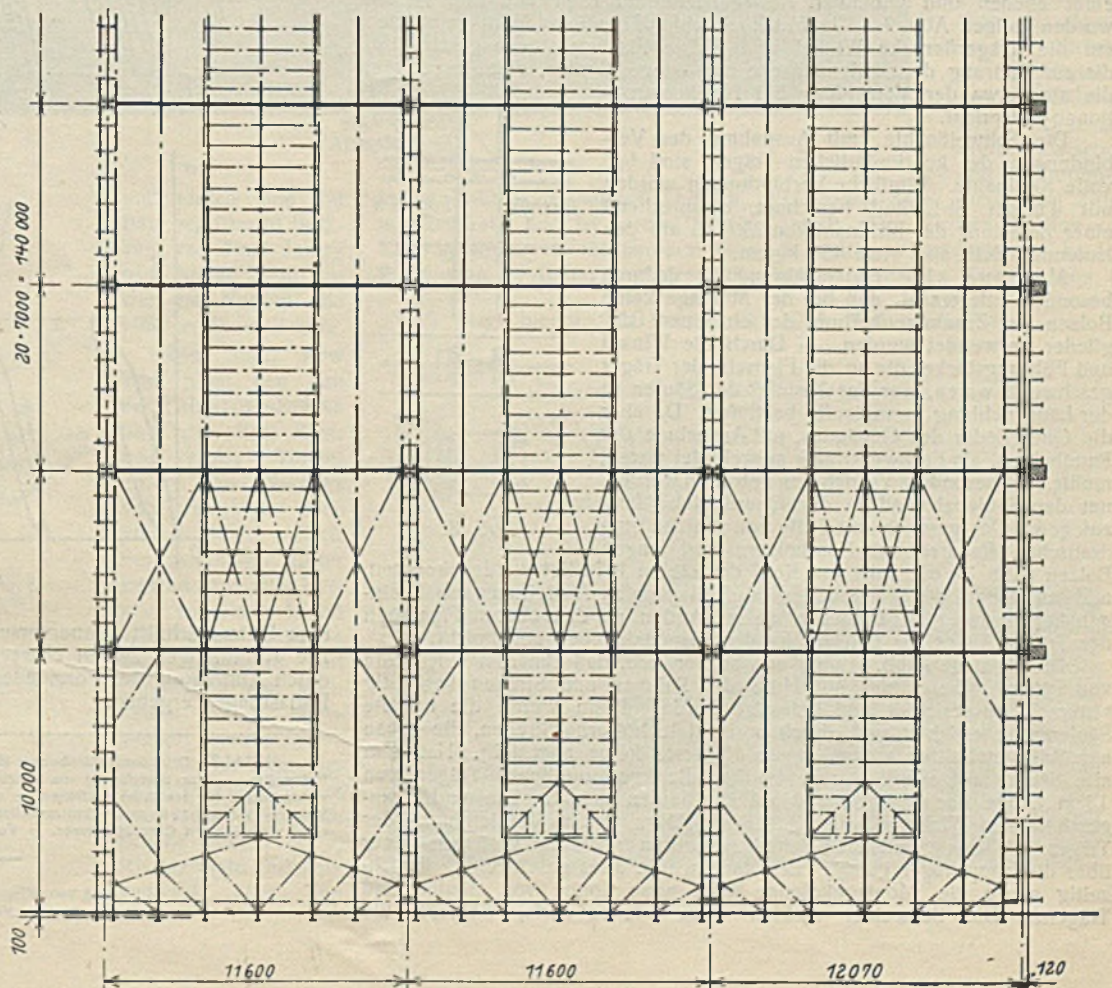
Querschnitt und Dachgrundriß der Hallen.
